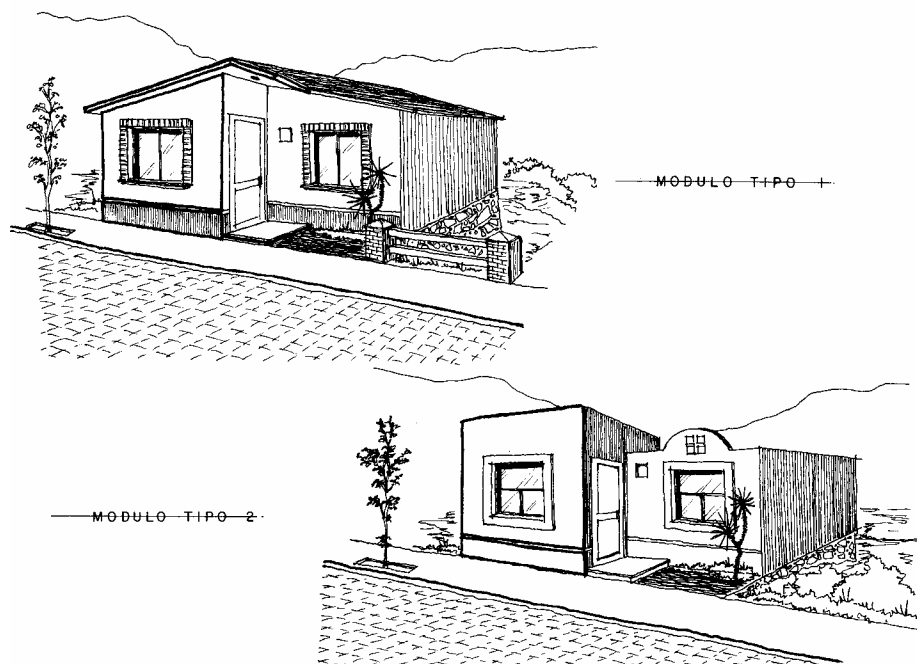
D. Módulo tipo de vivienda (fachada)
